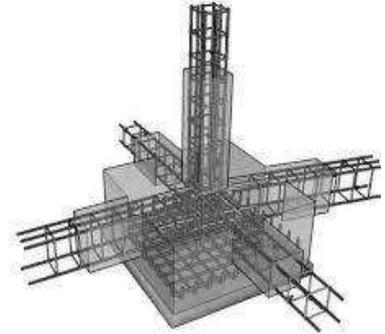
/3D de zapata/foto obtenida de sist. Constructivos pdf
